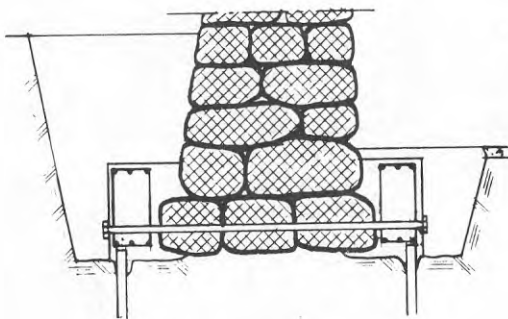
Grundförstärkning, tryckning av betongpålar till fastare jordlager.
